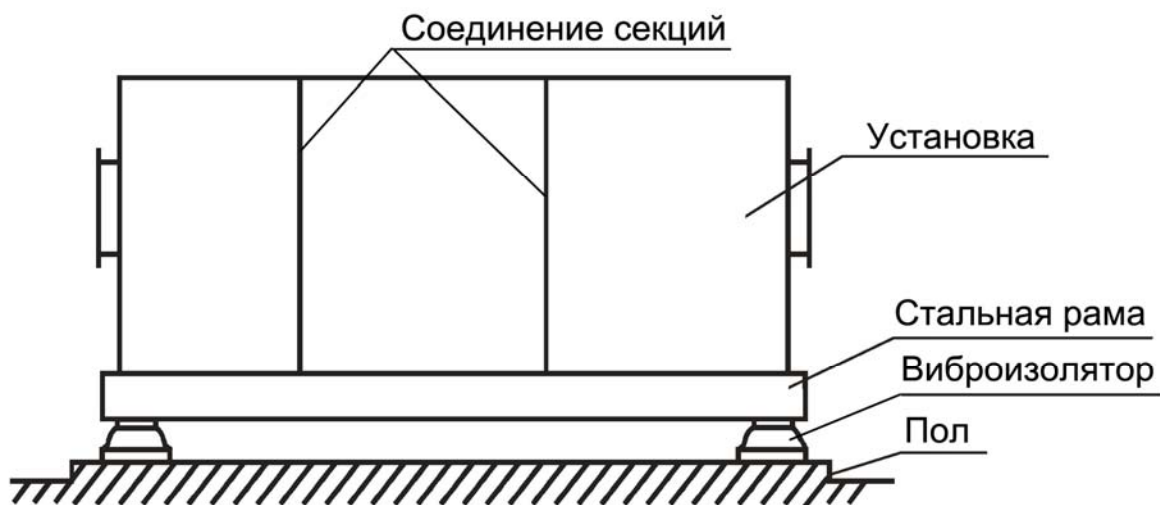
Размещение установки на стальной раме с виброизоляторами
